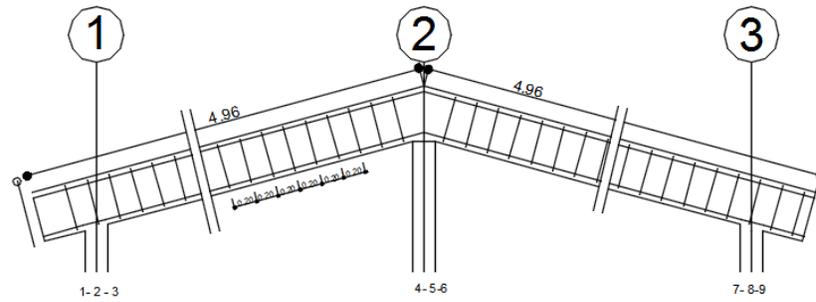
Detalle cubierta vivienda tipo proyecto "Nulti".
